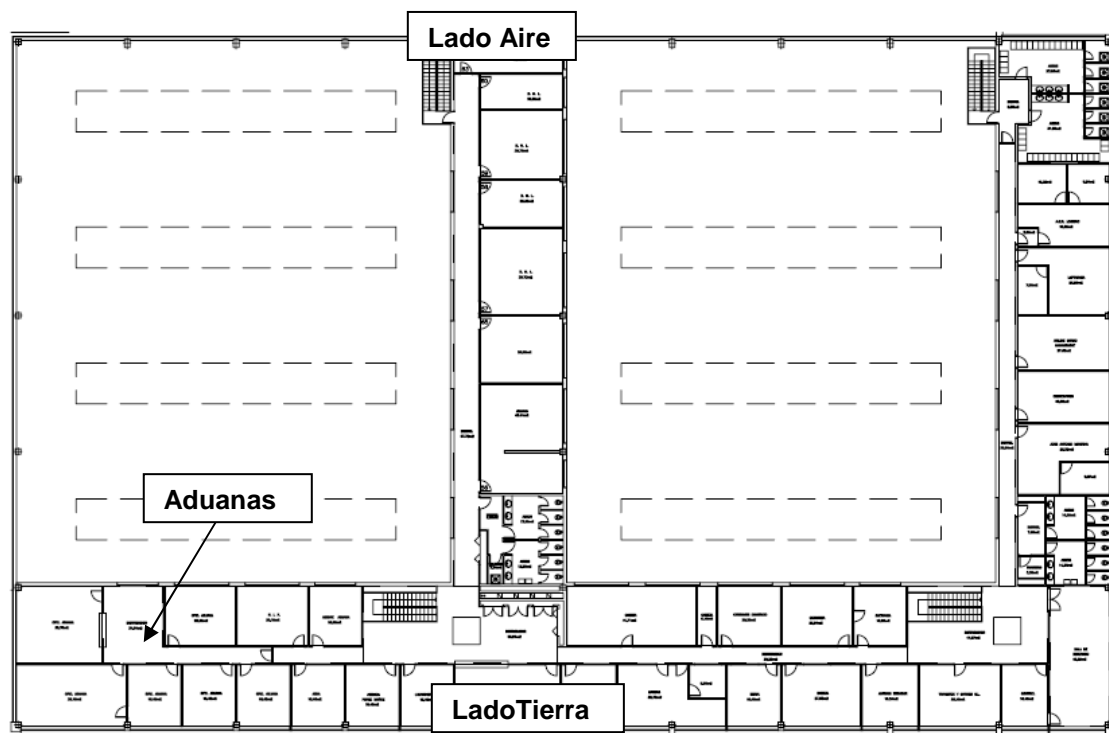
Distribución de la planta alta de la actual Terminal de Carga del Aeropuerto de Málaga. Fuente: Planos de Ineco.
